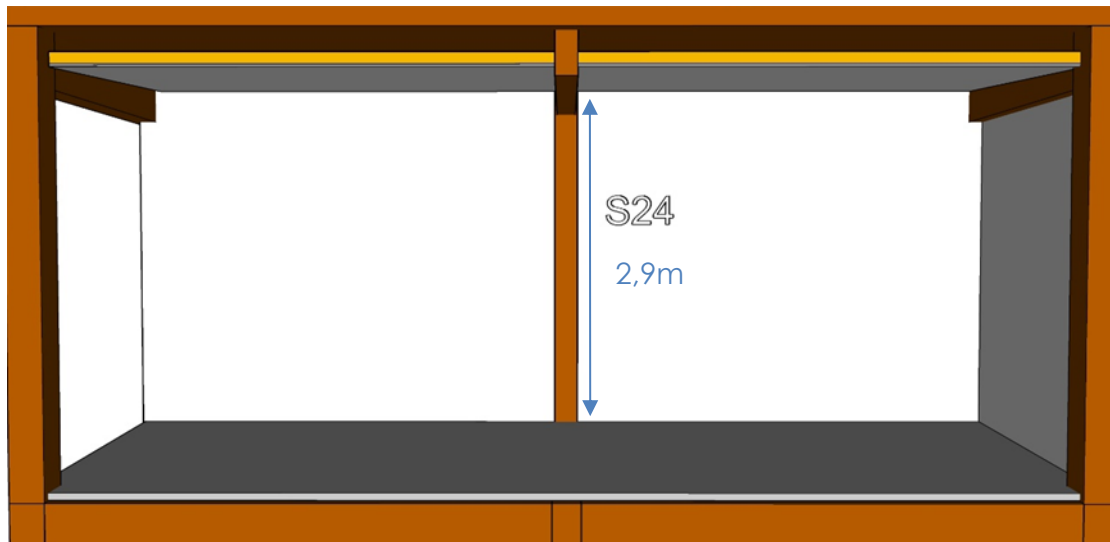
Vue du local S24 avec les poutres et un poteau apparent
